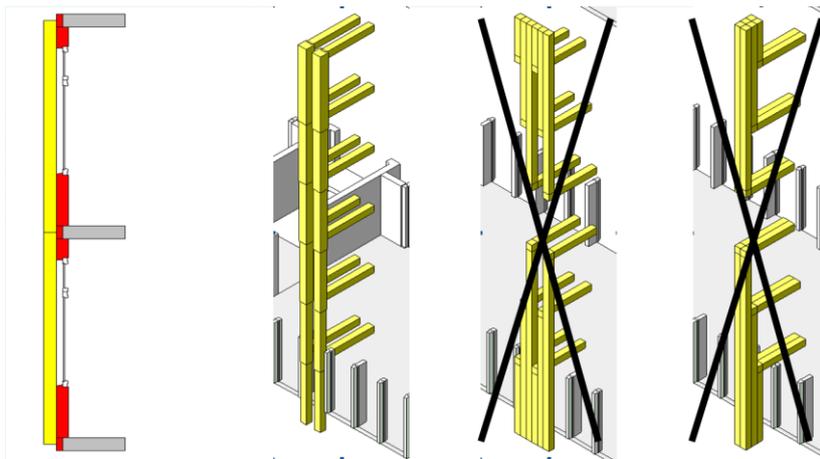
links Fassadenschnitt mit vorgehängten Modulen, rechts: diskutierte Rohrführungen in der Fassade
